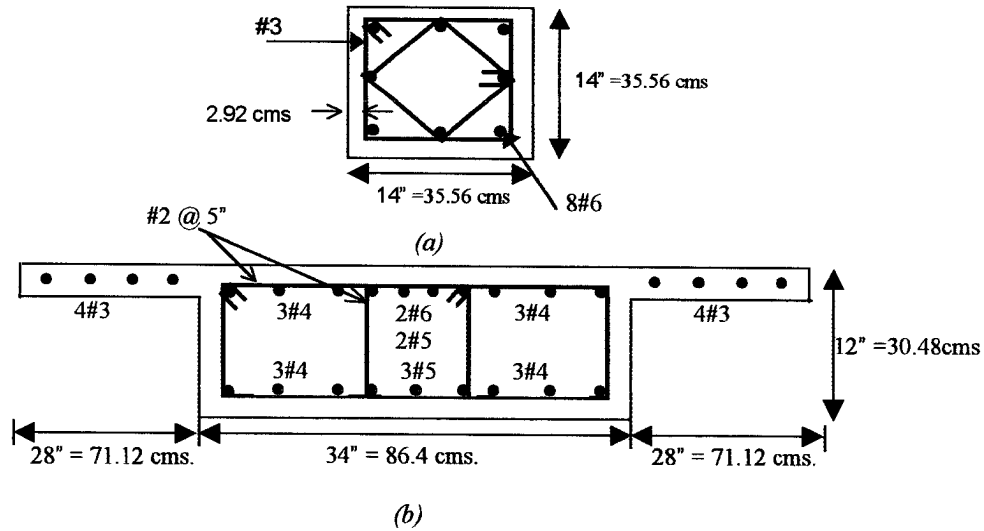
Detalles de la Sección de: (a) Columna (b) Viga del espécimen EWB2.[14]
